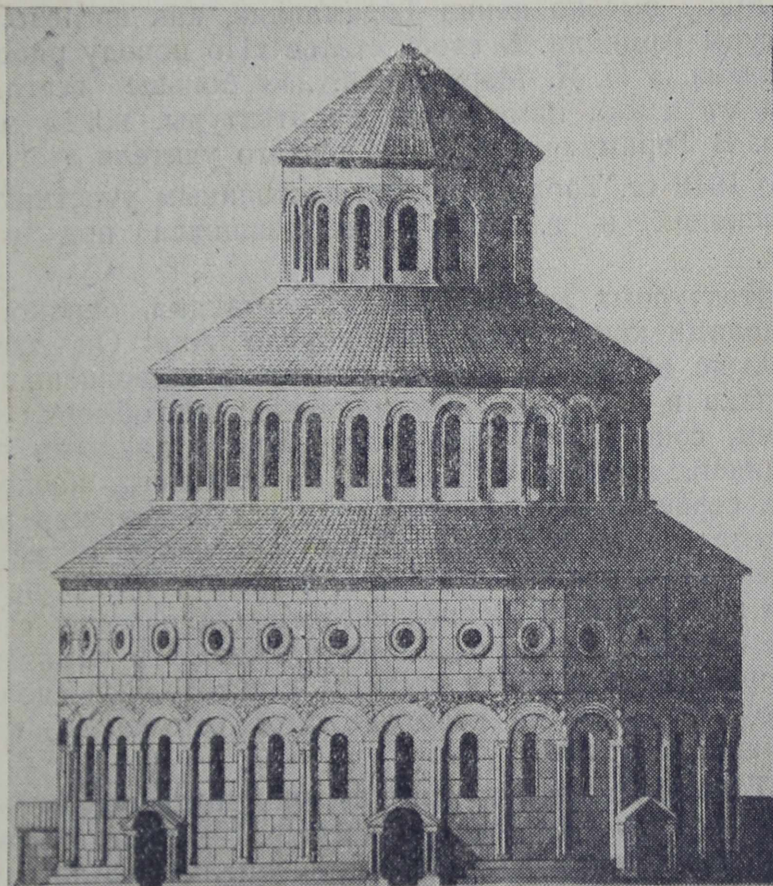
Храм Звартноц. Фасад (реконструкция арх. Тораманяна)
